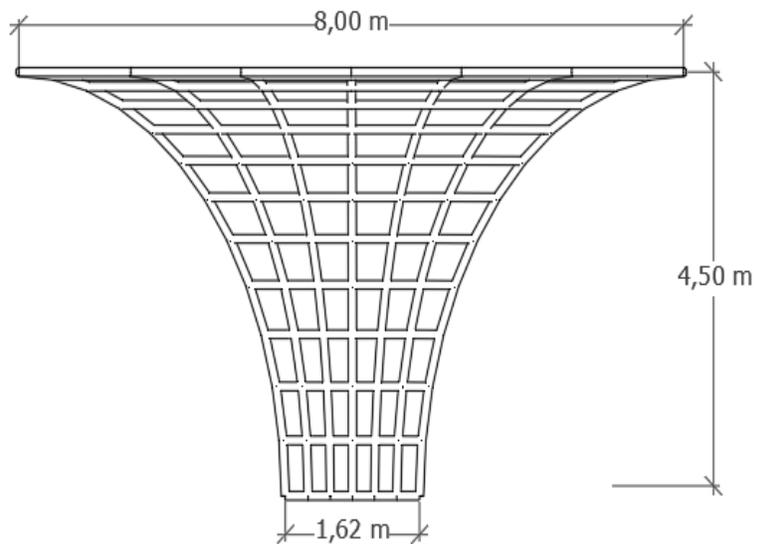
Estructura y medidas del módulo.(detalle estructural módulo, intervención propia)
